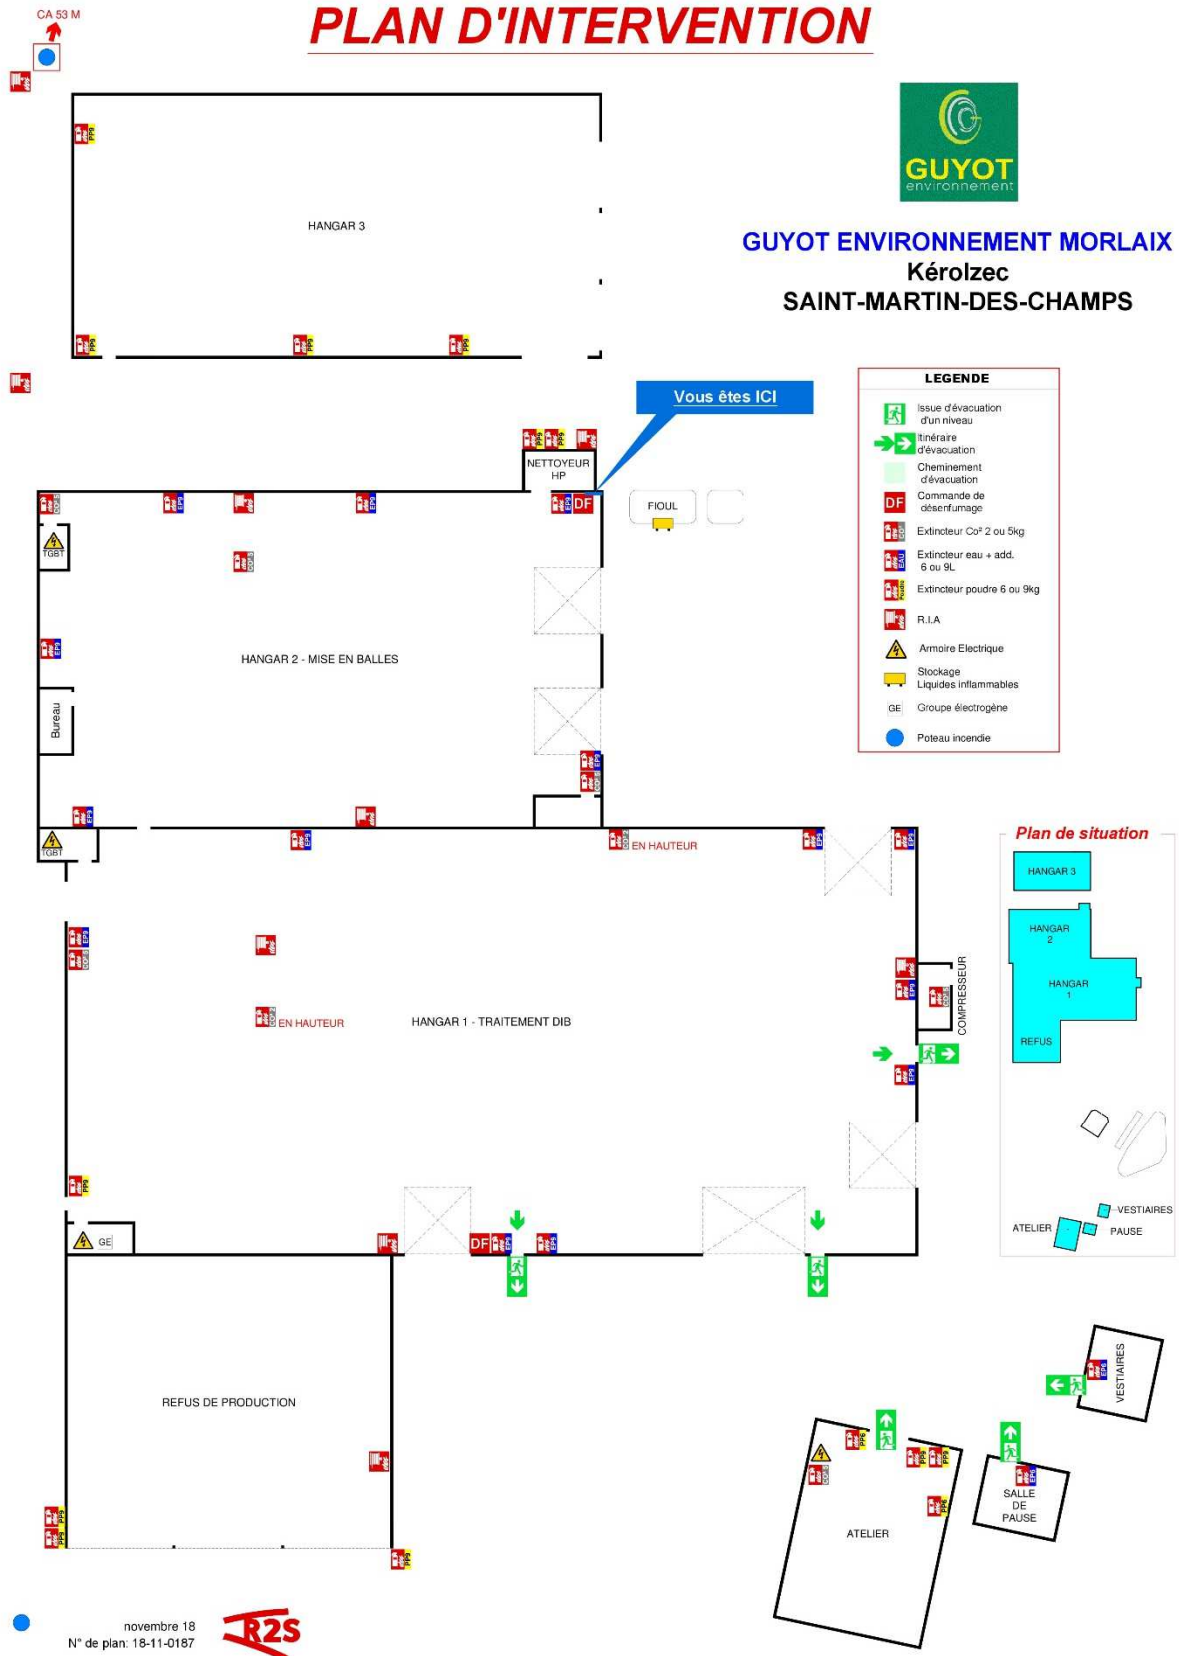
Plan d'implantation des extincteurs sur le site GUYOT Environnement
